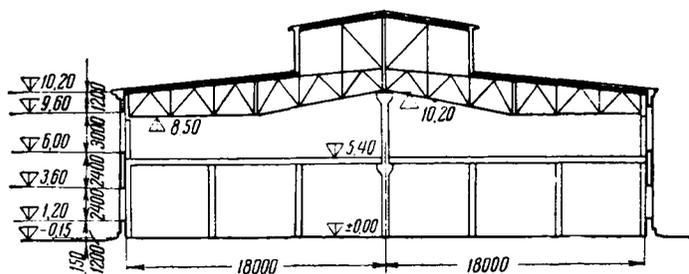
Здание 8-рамного лесопильного цеха с покрытием из металлических ферм (разрез)
